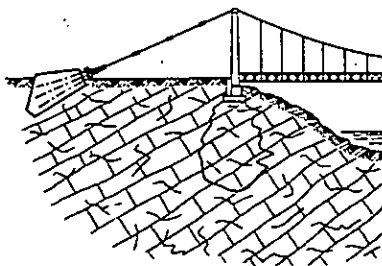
Roche fissurée, consolidation sous un pylône de pont (doc. Solétanche)
